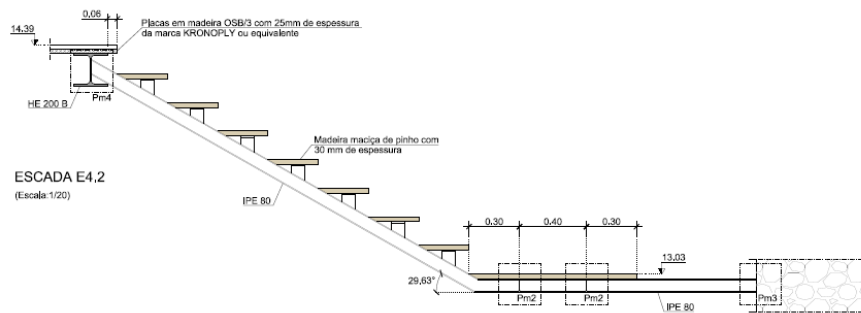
Pormenor das escadas para os restantes pisos [17]
